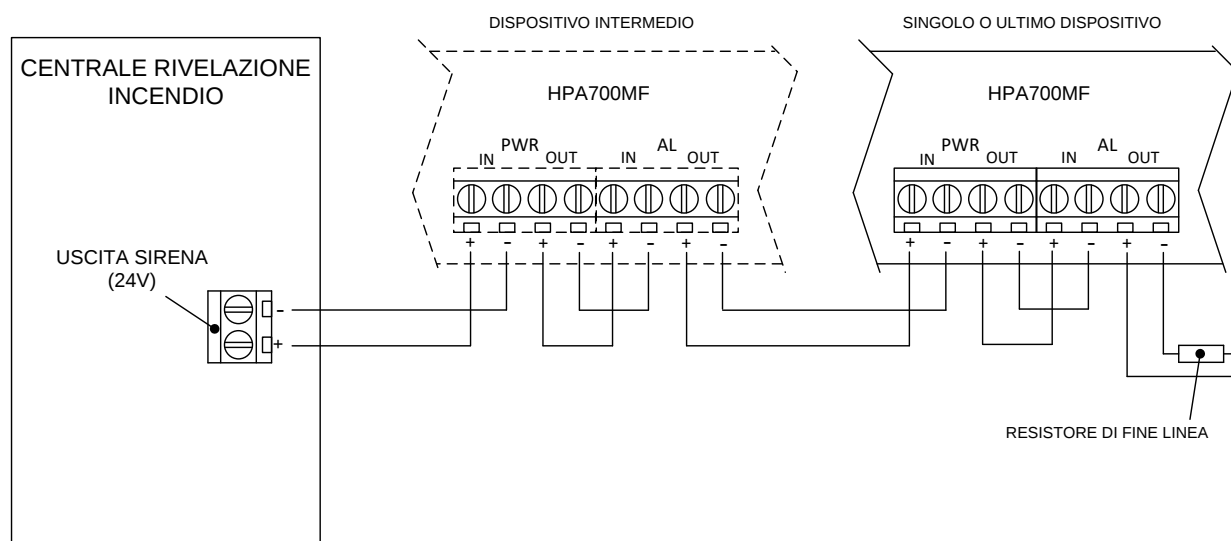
Alimentazione e pilotaggio della/e sirena/e direttamente dall'uscita segnalazione allarme incendio della centrale
